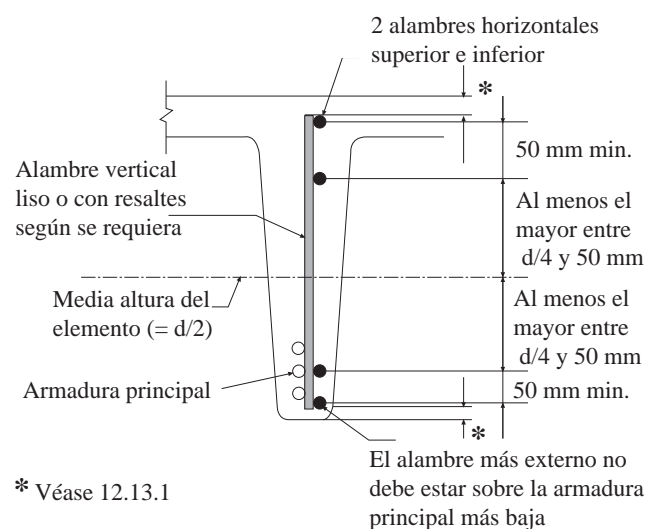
Anclaje de la armadura de corte formado por una rama de malla electrosoldada de alambre.
